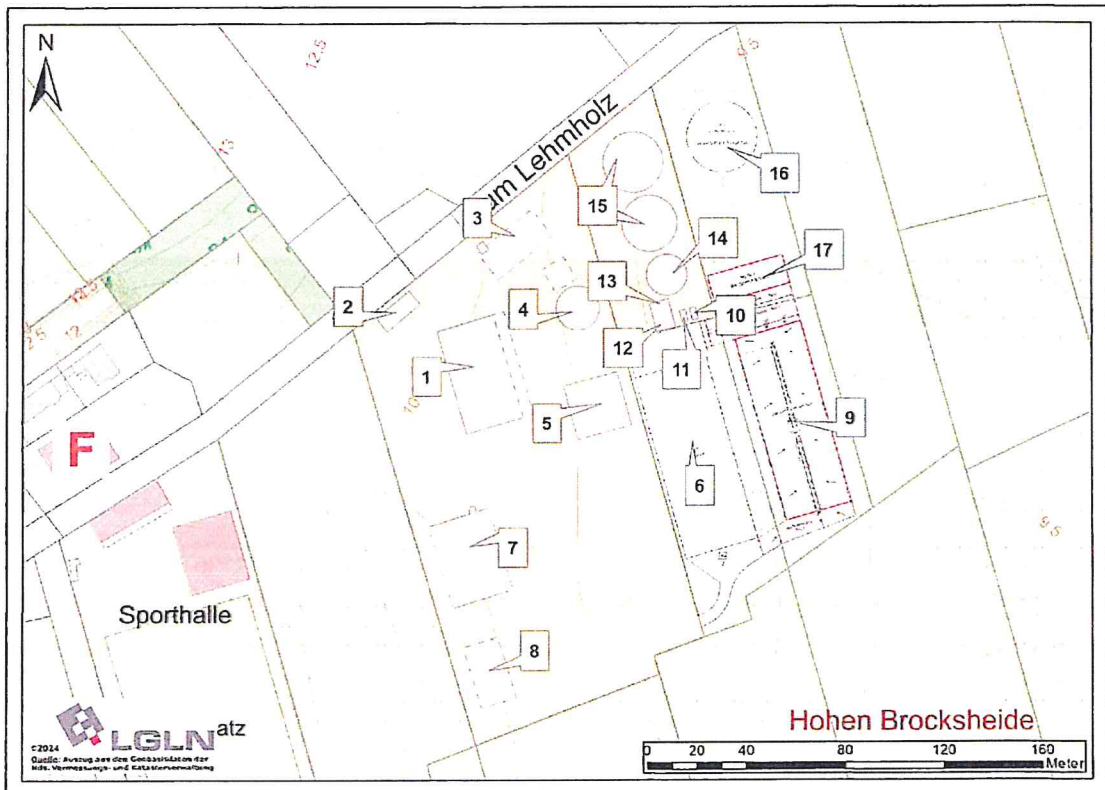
Gebäudeplan der erweiterten Anlage im Außenbereich von Bramstedt.
